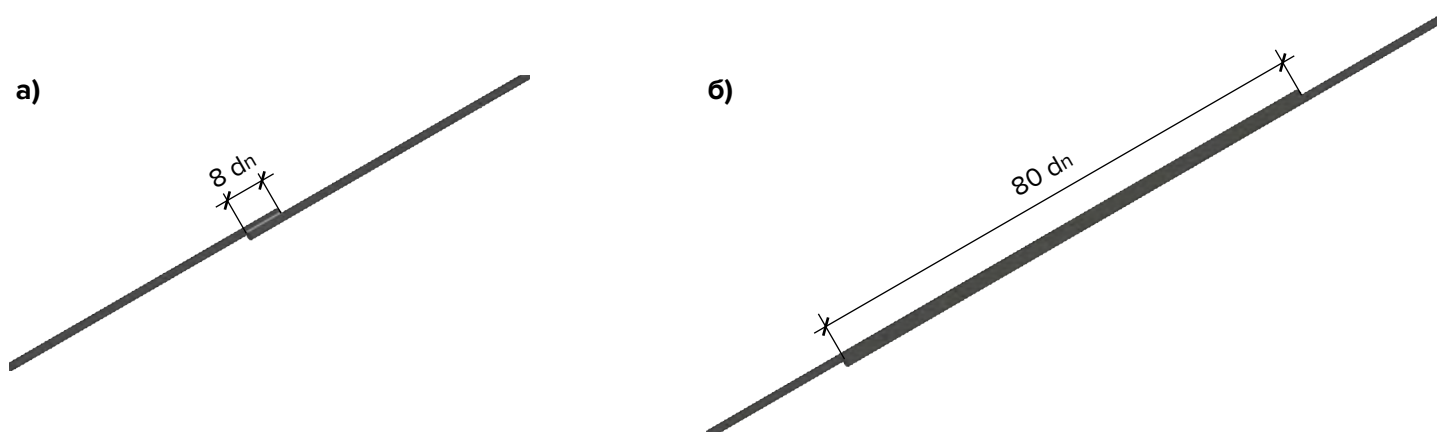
Соединение арматурных стержней рядового армирования в штрабах
